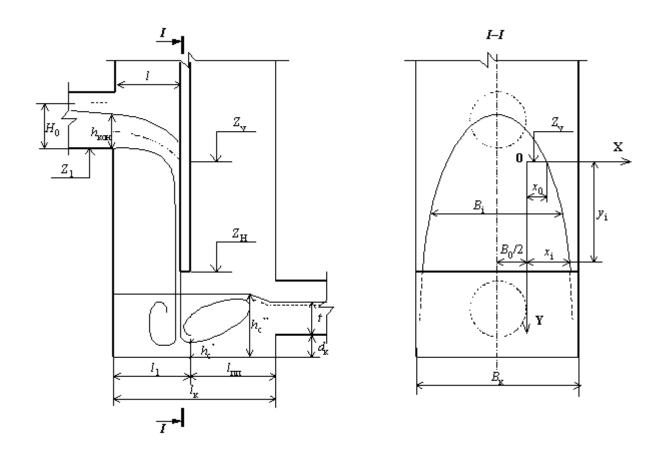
Схема к расчету перепада с отбойно-водосливной стенкой
